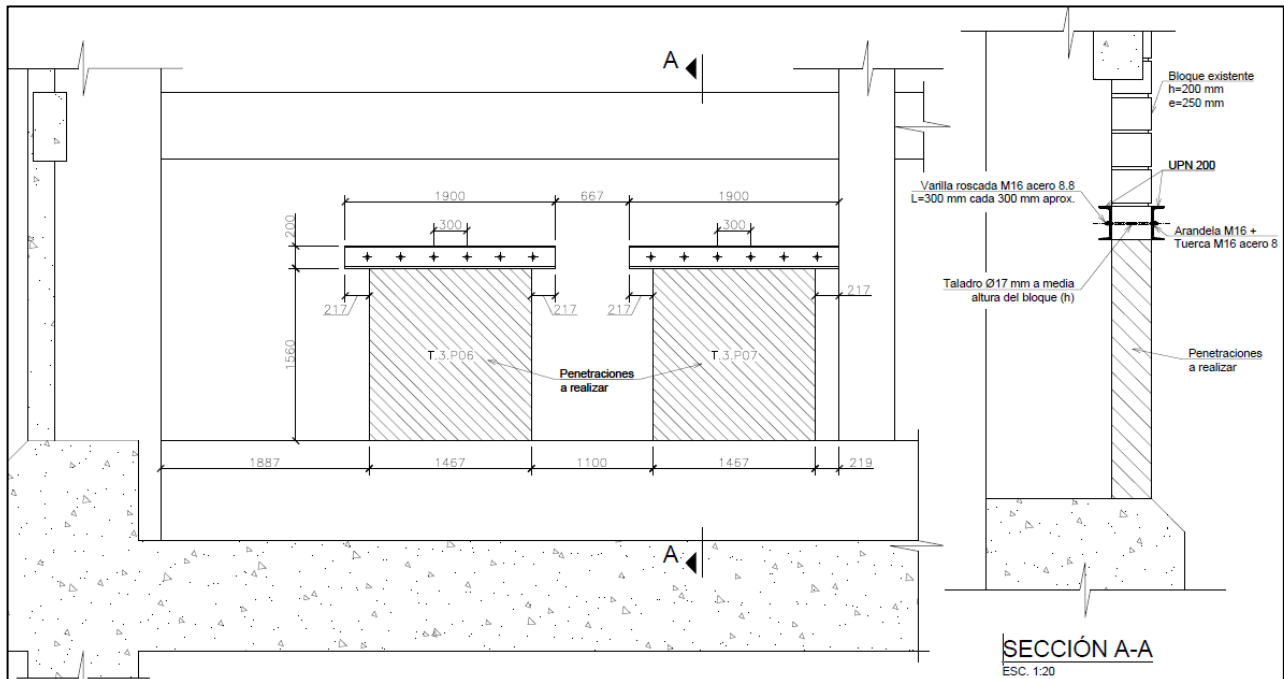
Detalle de instalación estructura metálica dintel en penetraciones PNT-T.3.P06/P07
